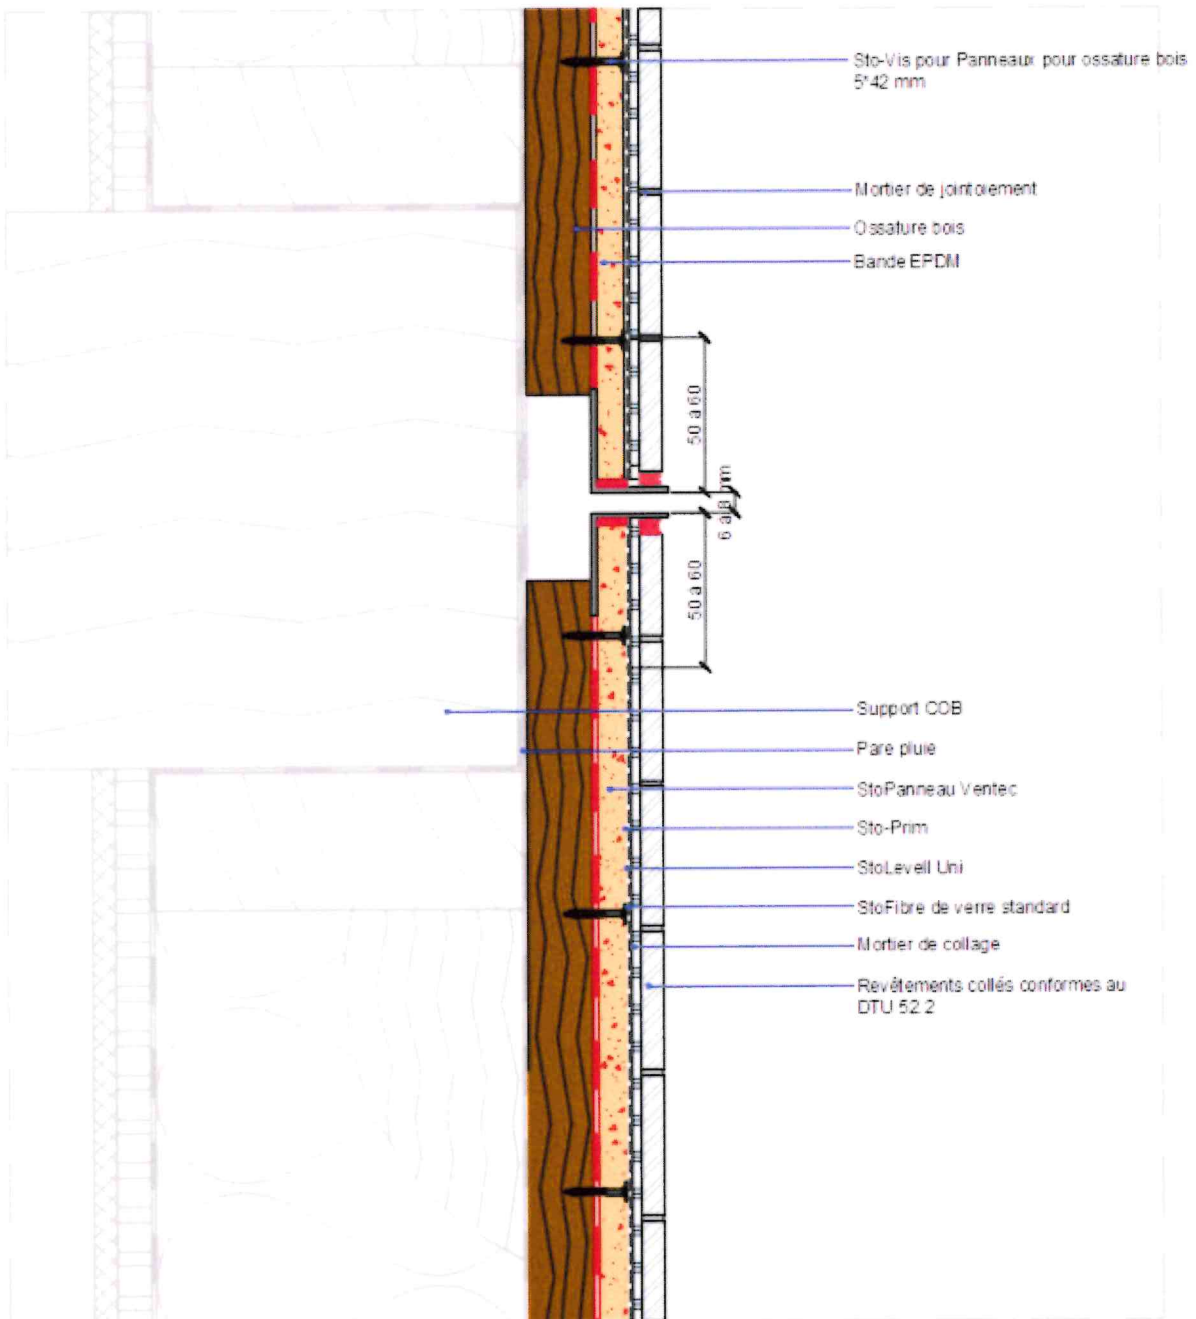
Détail de la jonction de système StoVentec SCM / Enduits sur plaque courante
